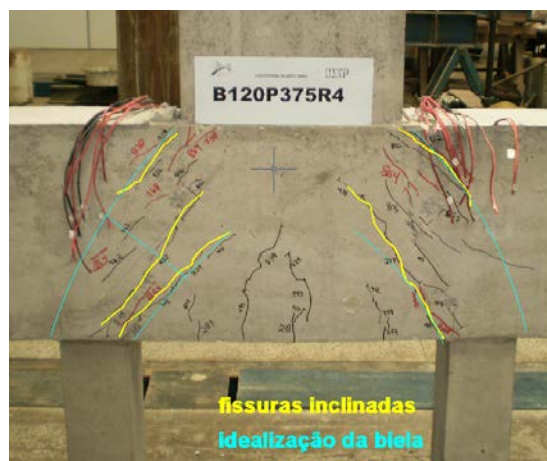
Formação de fissuras inclinadas B120P375R4
